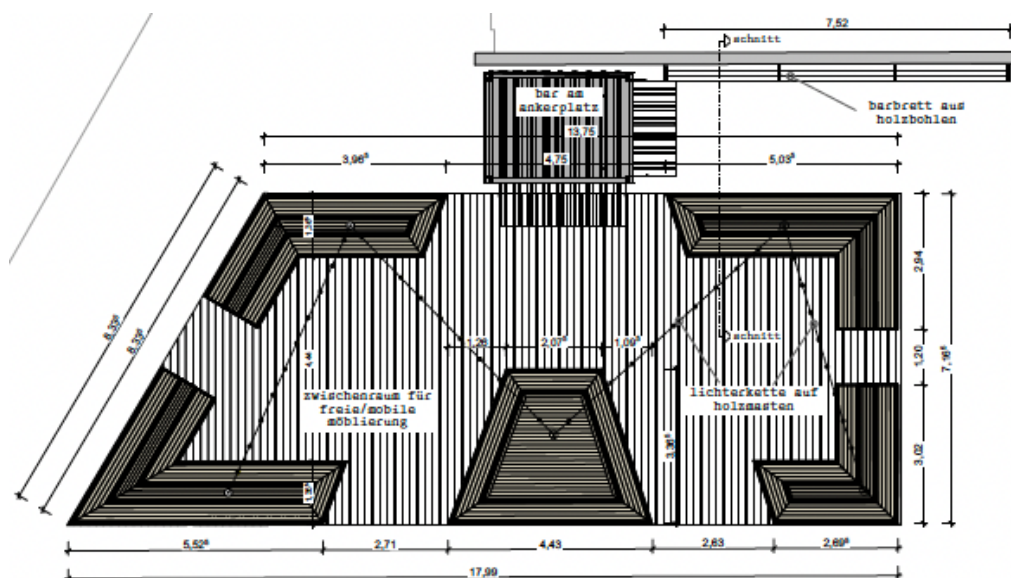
Grundriss "Ankerplatz" (Quelle: Architekturbüro Ladehoff, Stand 08-2024)
